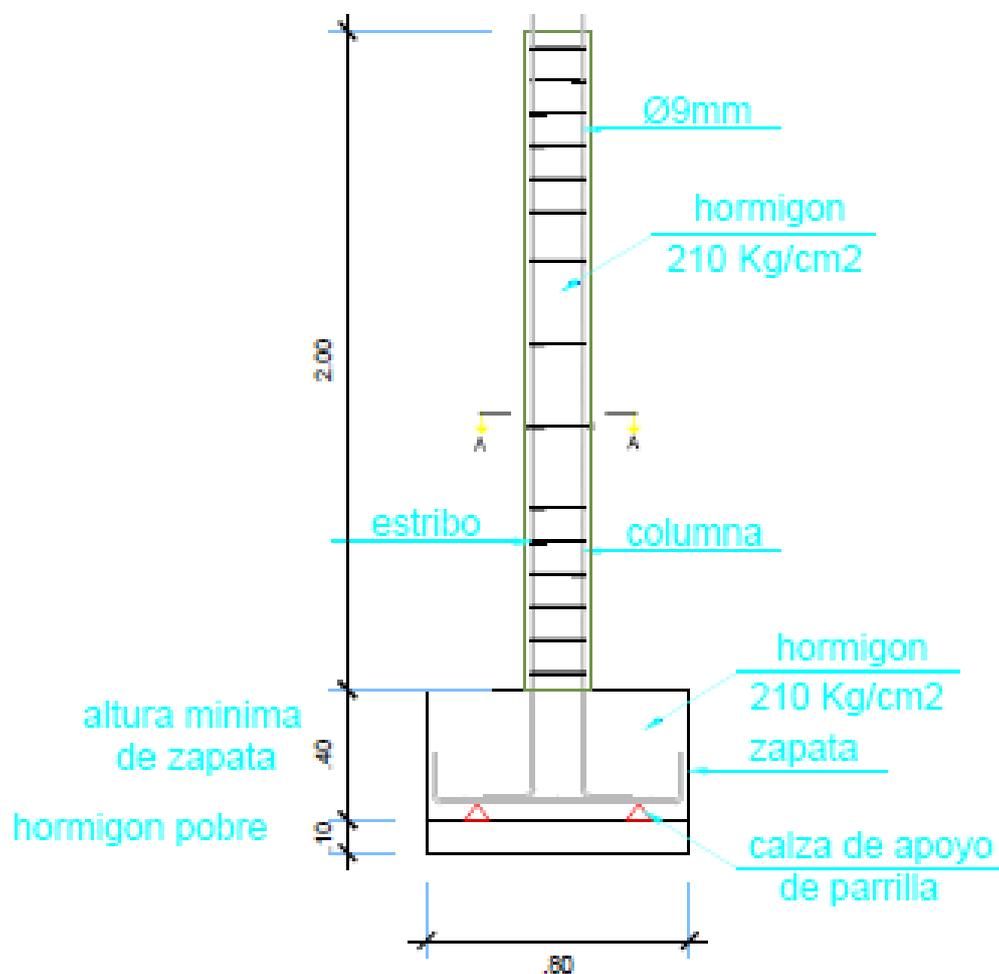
Detalle corte frontal de columna tipo en hormigón armado.
